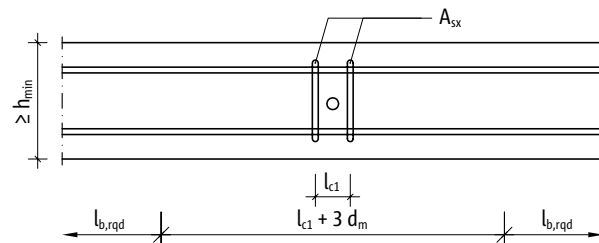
Schöck Dorn type LD: Kundeudført armering
